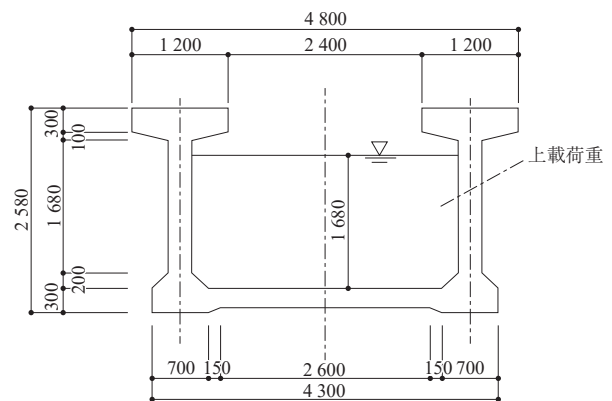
細ヶ沢水路橋の断面図（単位：mm）
